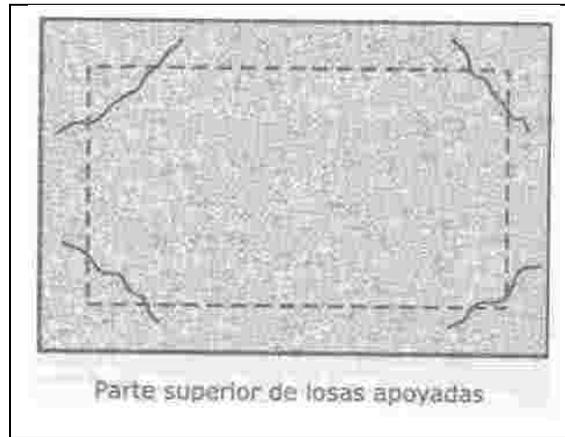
Fisuras de momentos torsionales²¹
